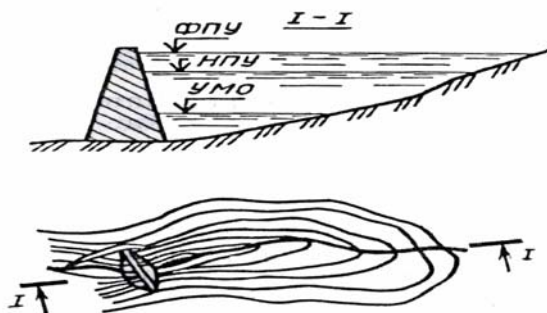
План и схематический продольный профиль водохранилища
